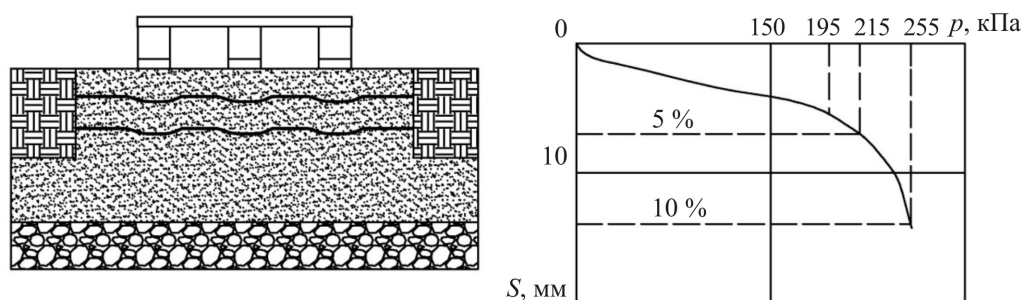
Модель подушки с двухслойным армированием с предварительным напряжением армирующих слоев за счет очередности послойного уплотнения: 1 – штампы; 2 – слой армирования; 3 – зоны средних перемещений; 4 – зоны минимальных перемещений
